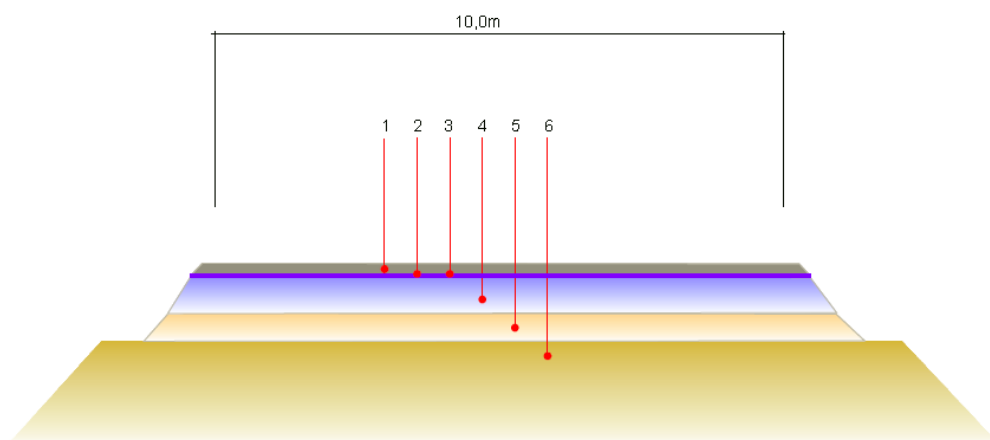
Seção transversal do pavimento - vias marginais BR-020/DF (DNIT, 2008)
